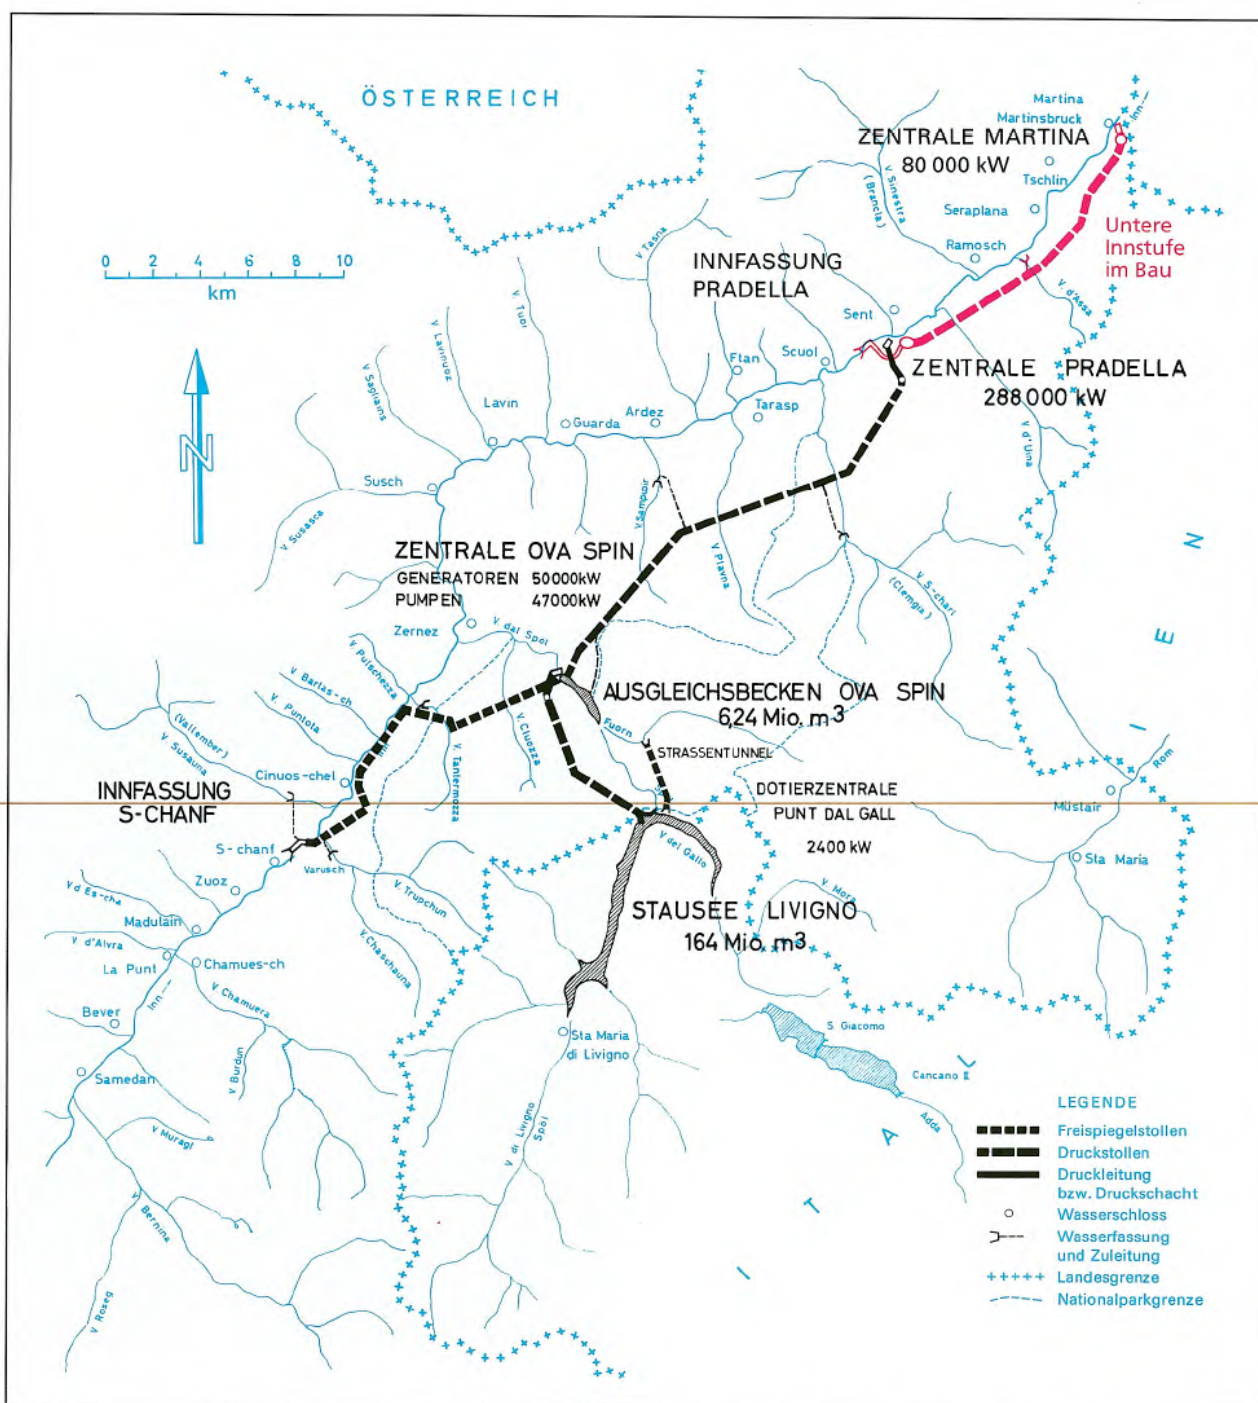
Übersichtsplan der Kraftwerksanlagen mit den Zentralen Ova Spin und Pradella sowie Kraftwerk Pradella-Martina im Bau.
